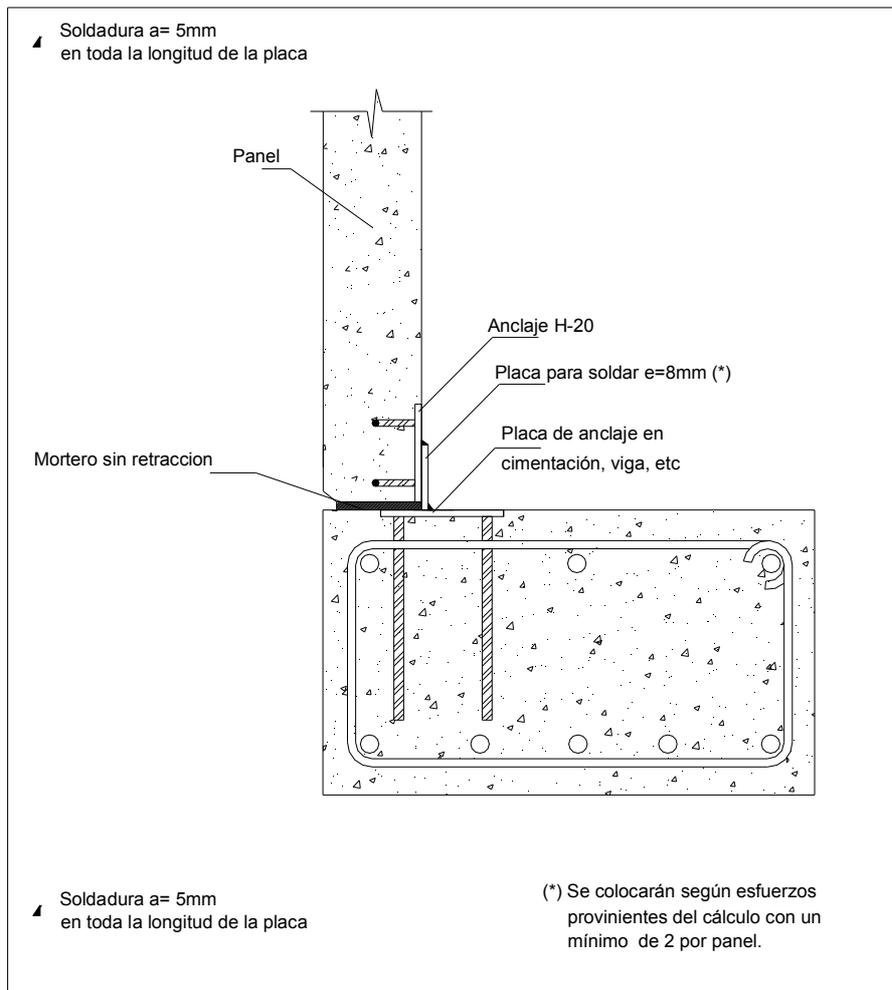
ARRANQUE DE PANEL EN CIMENTACIÓN, VIGA, ETC.
